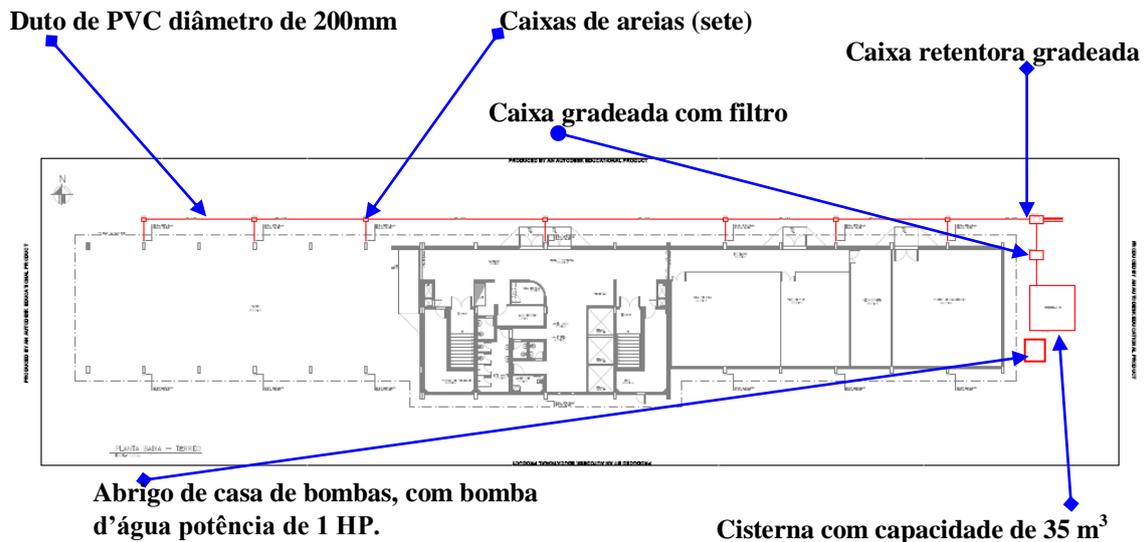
Planta baixa e detalhe da cisterna a ser construída próxima à ala direita do prédio do bloco “O”
